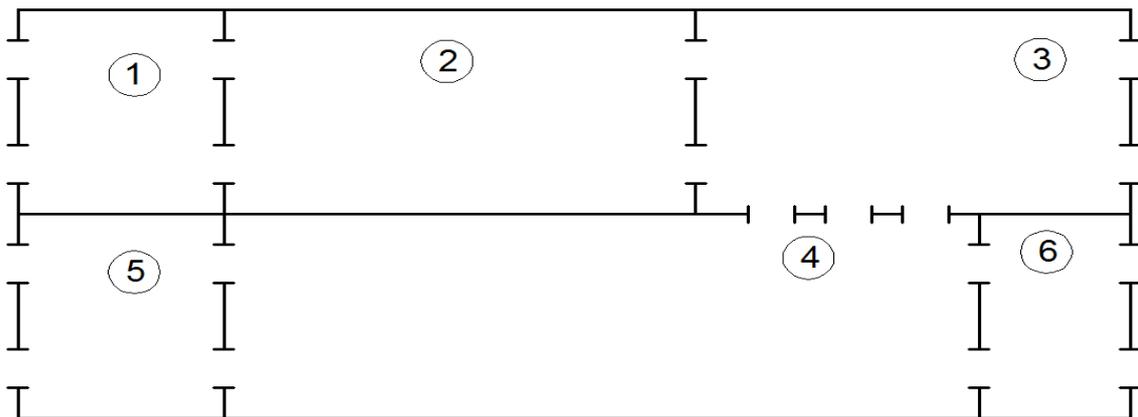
Схематичное расположение отделений главного корпуса автозавода при параллельном блокировании корпусов
